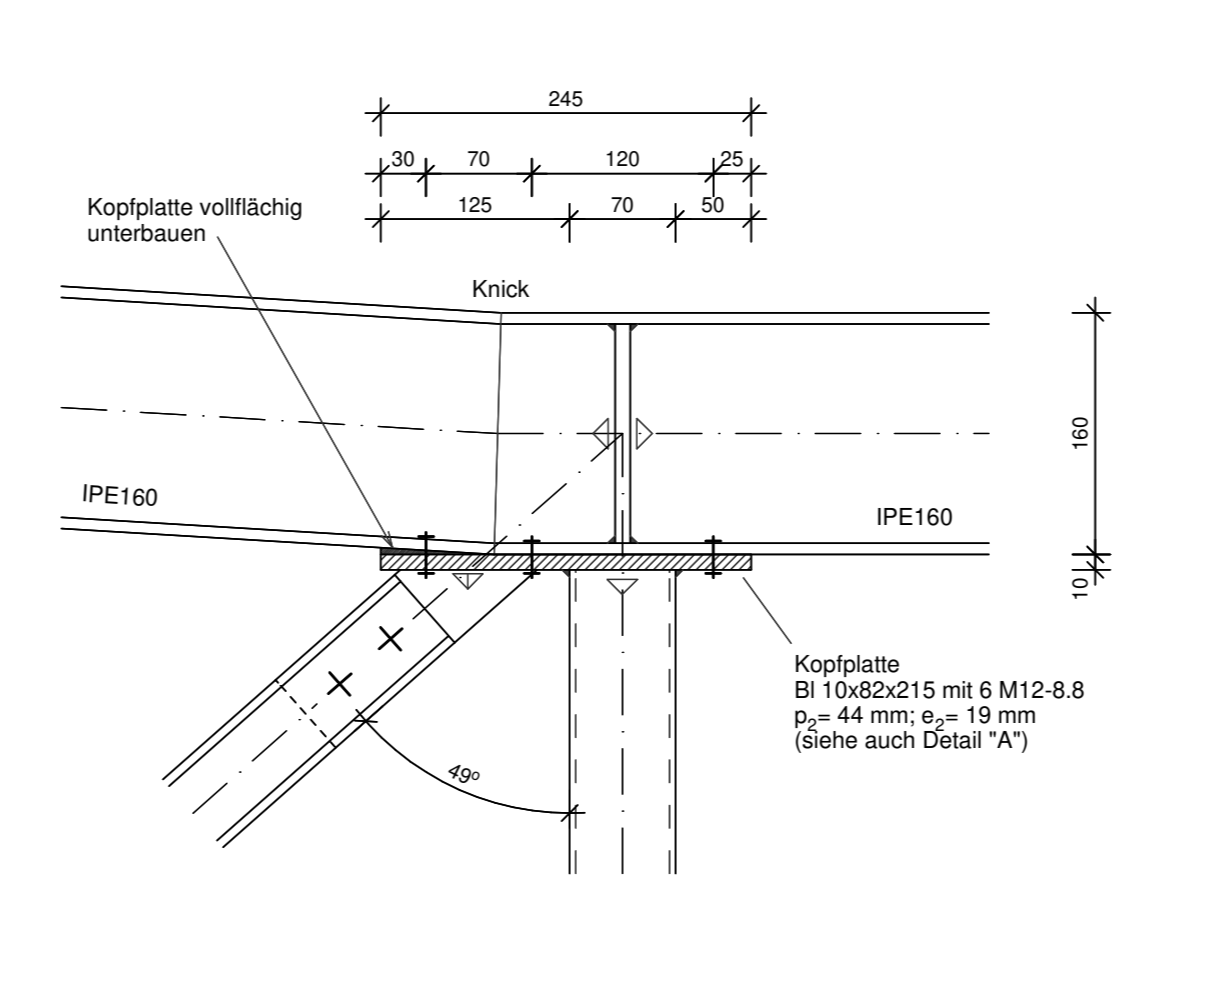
5 Knotenpunkt Oberturt Achse 3
